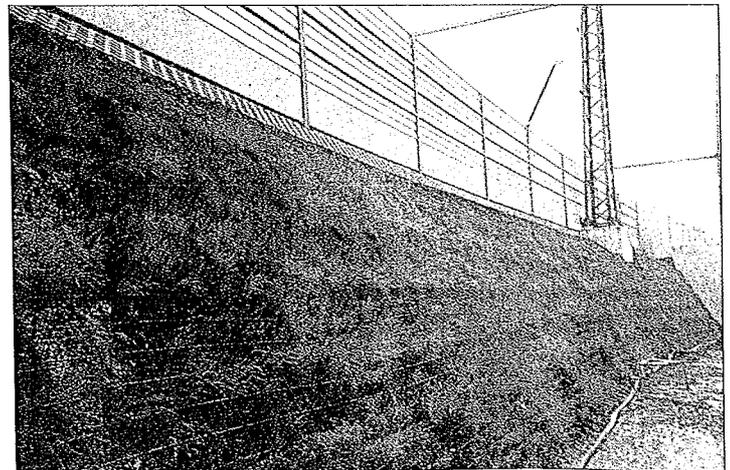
Kombinierte Lärmschutzmaßnahmen mit aufgesetzter Lärmschutzwand auf bewehrtem Wall an einer Eisenbahnstrecke
